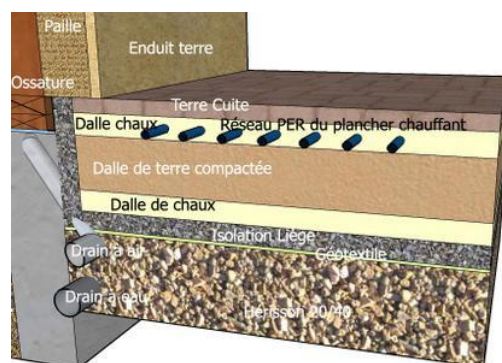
Détail d'un dallage sur hérissron. Source : <http://biozhome.over-blog.com/article-19277313.html>
